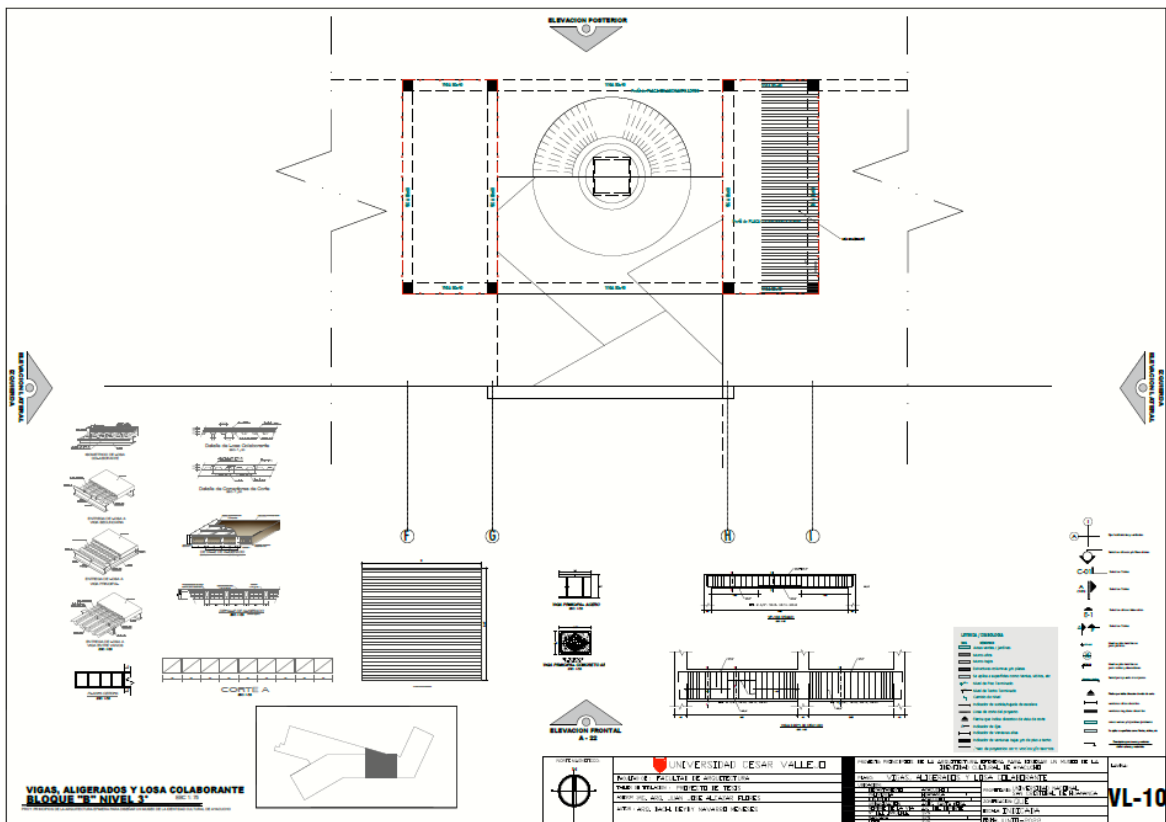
Plano de Vigas y Losas bloque D tercer nivel
